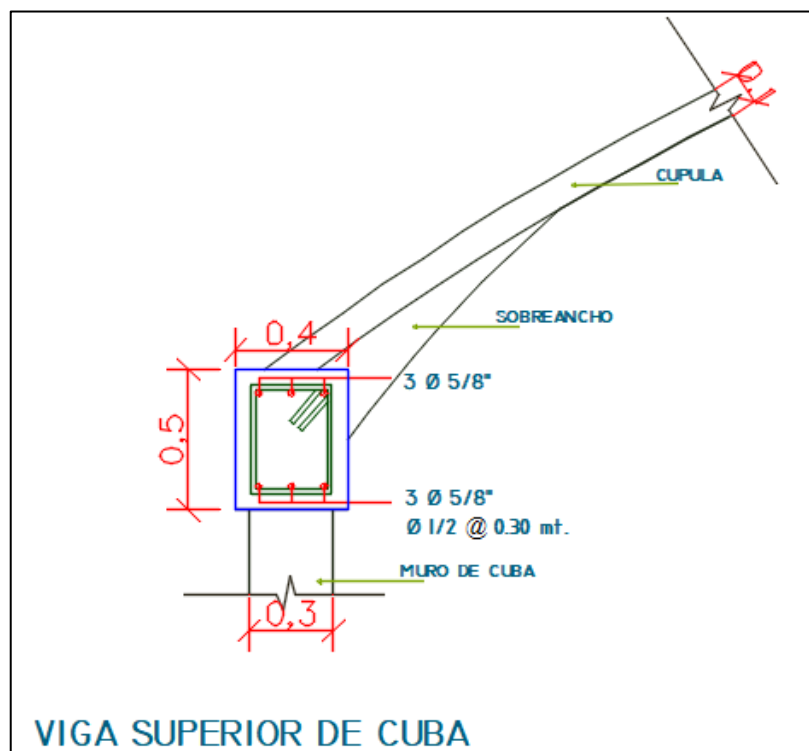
Plano de detalle de distribución de acero en la viga superior de la caba.
